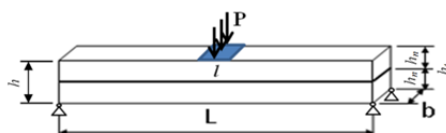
Модель балки с пенополистирольными и армирующим стеклотканевым слоями
